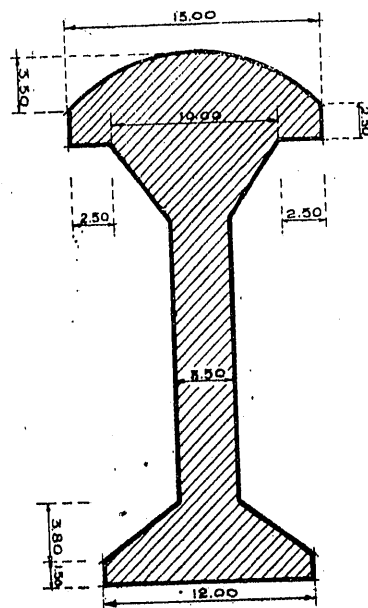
ª — Presa de Ullivarri. Planta de un contrafuerte.
